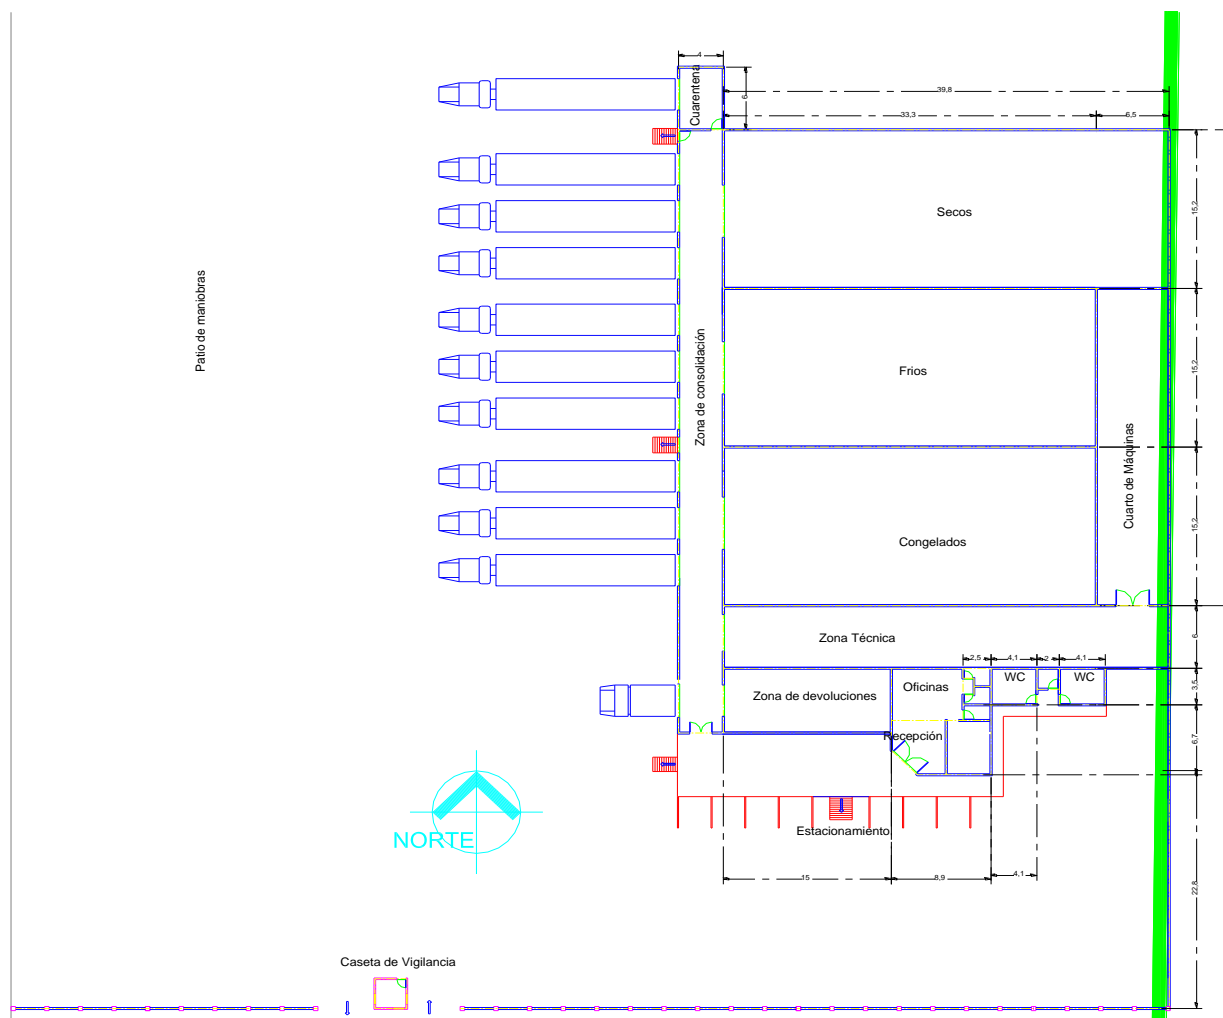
Propuesta de la planta arquitectónica de conjunto (a primer nivel de detalle) de un Centro de Operaciones Logísticas
